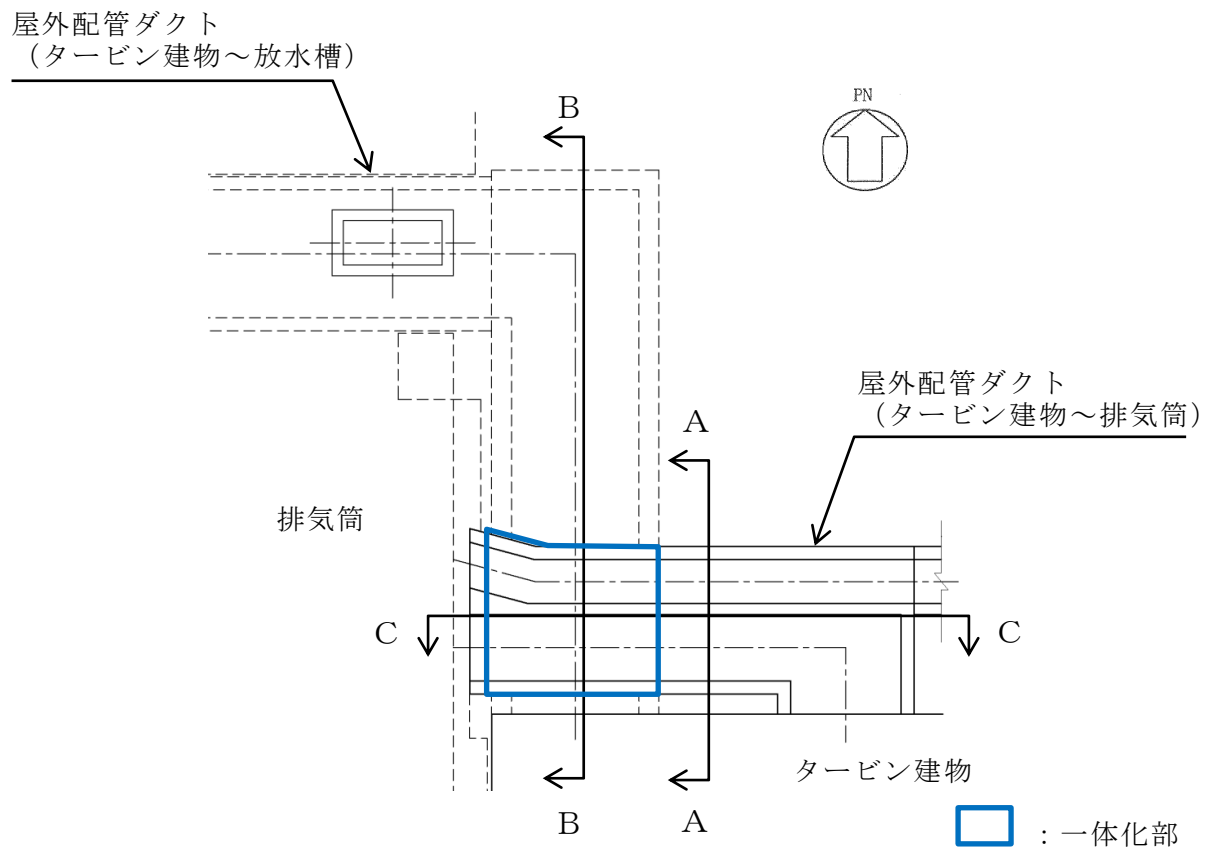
屋外配管ダクト (タービン建物～排気筒) 平面図
